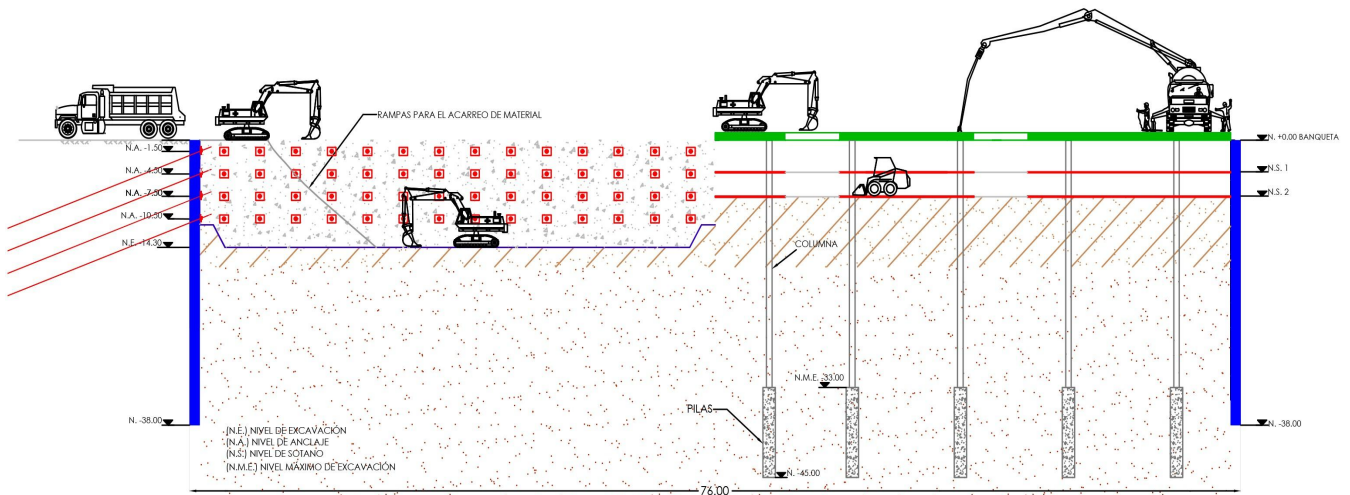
Excavación para ejecución del 4to nivel de anclaje y 2do sótano.
